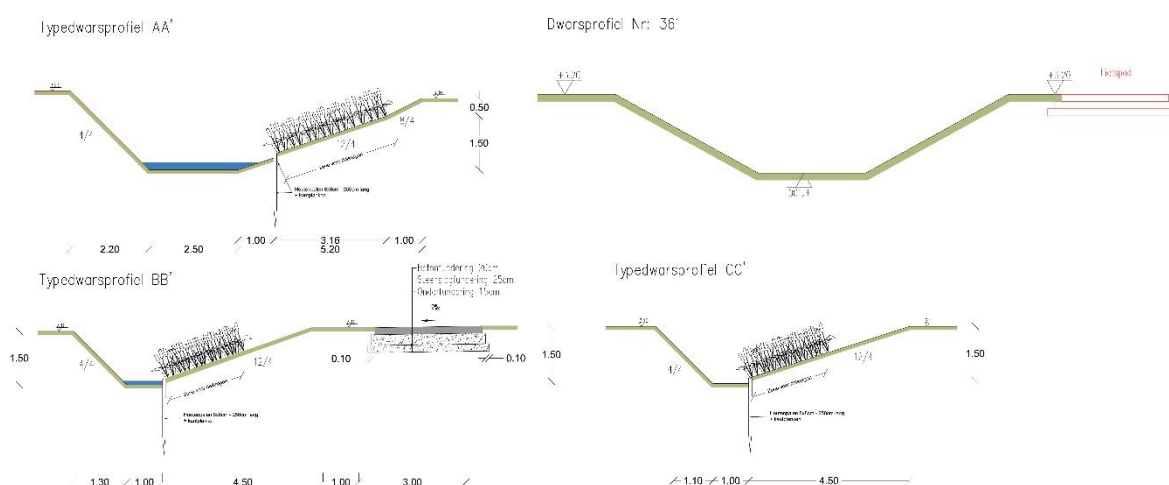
Ontwerpplan van het westelijk gedeelte van de westelijke fietsstrook (Bron: VLM)
